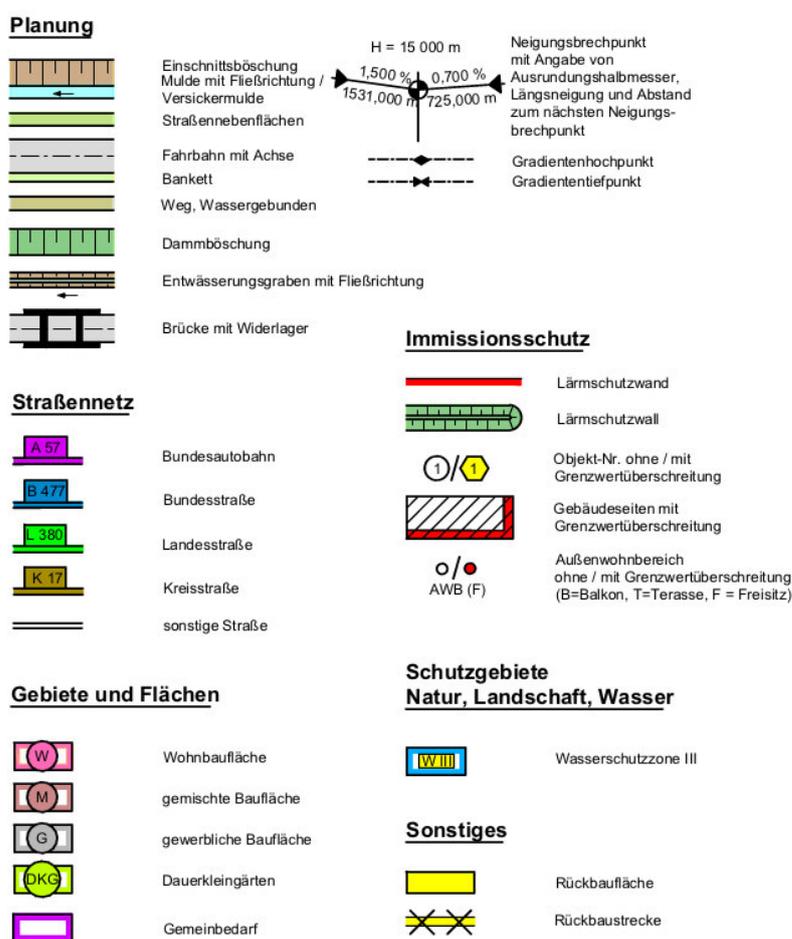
Zeichenerklärung des Übersichtslageplans (Straßen NRW 2017 Planfeststellungsunterlagen)
